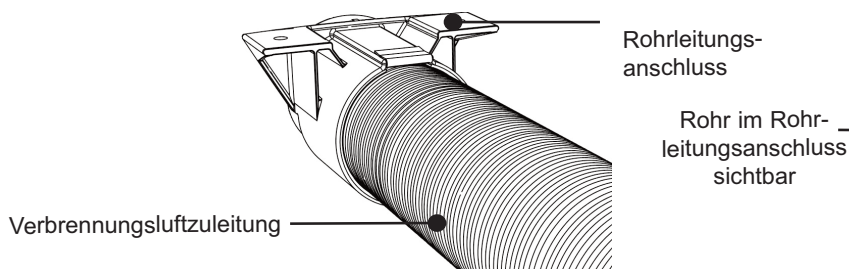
B Verbinden der Rohre (Gas/Luft) mit dem Rohrleitungsanschluss
